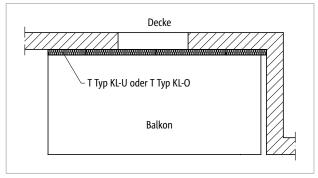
Schöck Isokorb® T Typ KL-U/KL-O: Balkon bei Fassadenversprung
